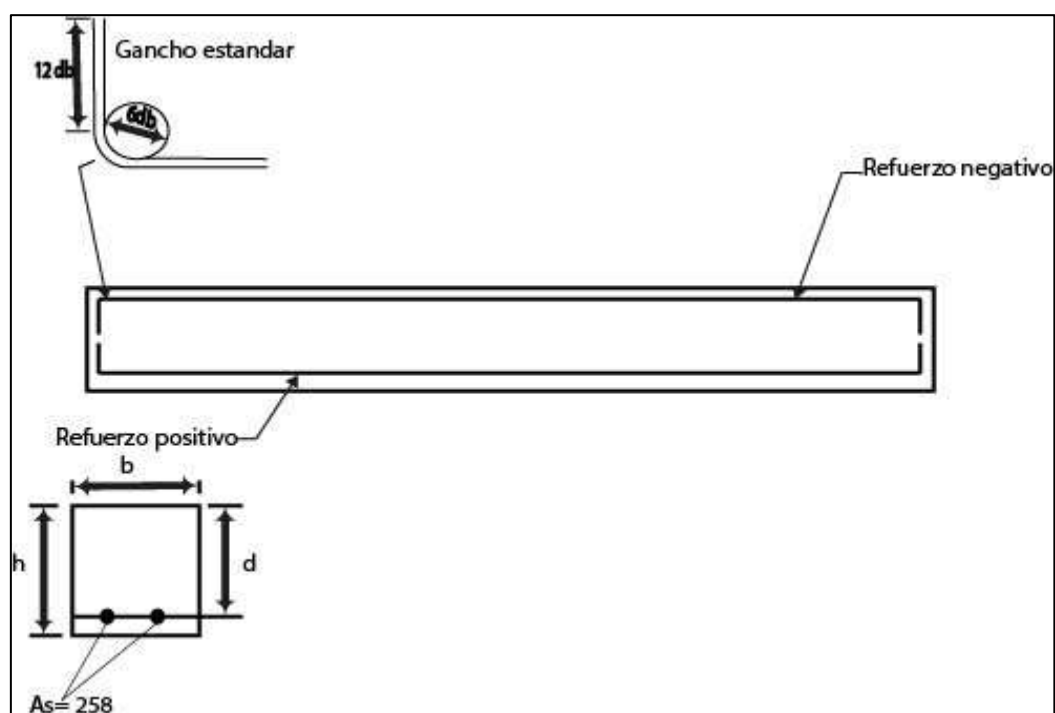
Detalle de refuerzo de viga; Fuente: [Grupo investigador]
